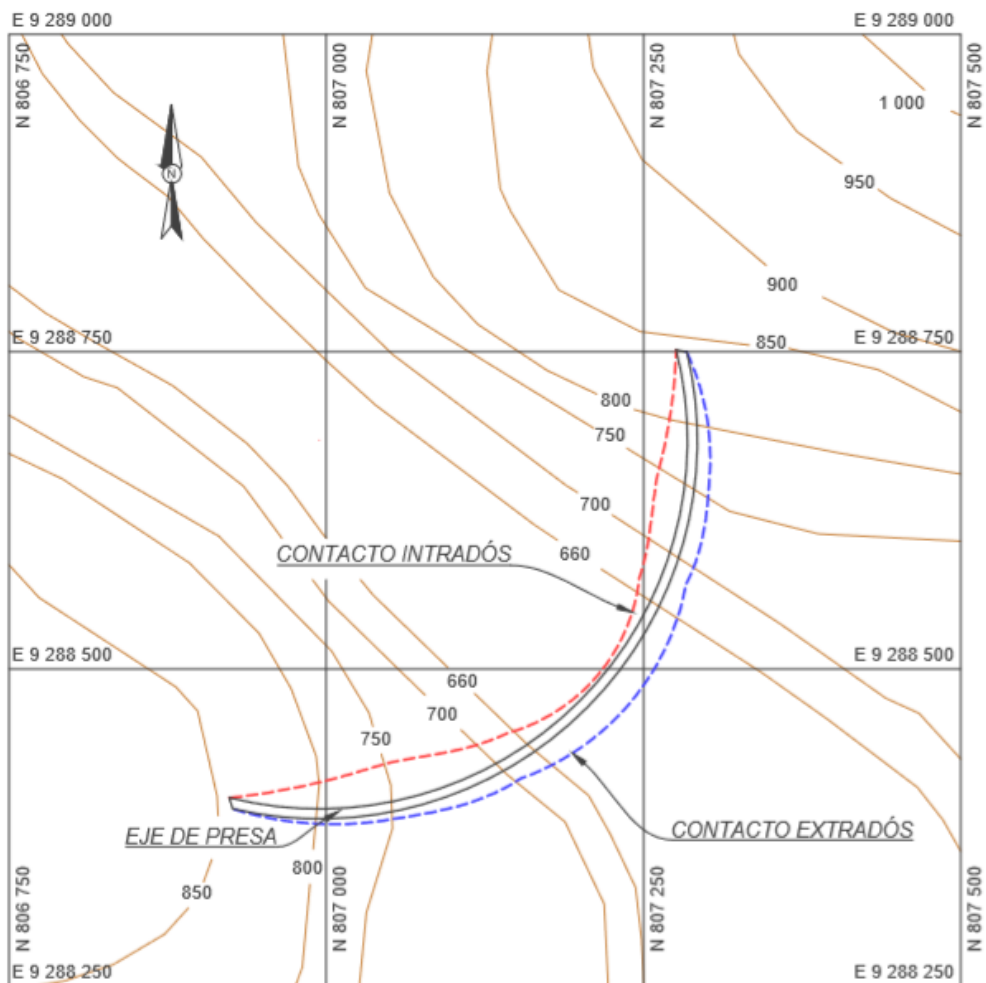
Vista en planta del contacto Intradós y Extradós con la roca de fundación
